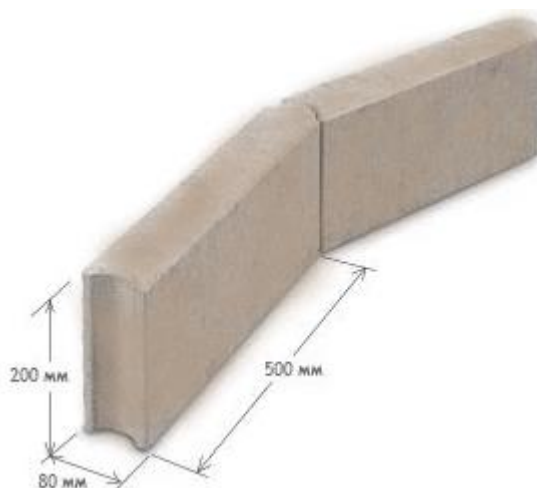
Шарнирный бортовой камень, цвет Какао
